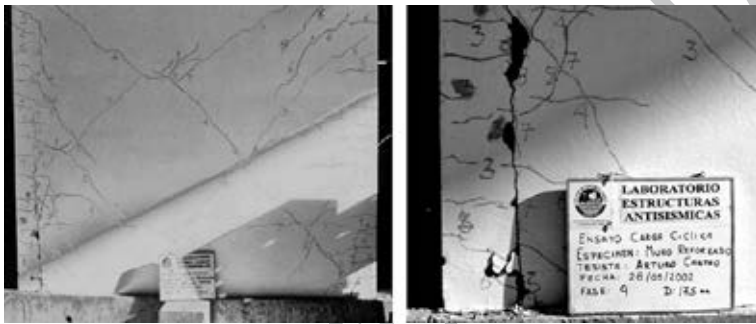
Muro confinado reparado (izq.) y grieta vertical en la unión columna-albañilería (der.).
